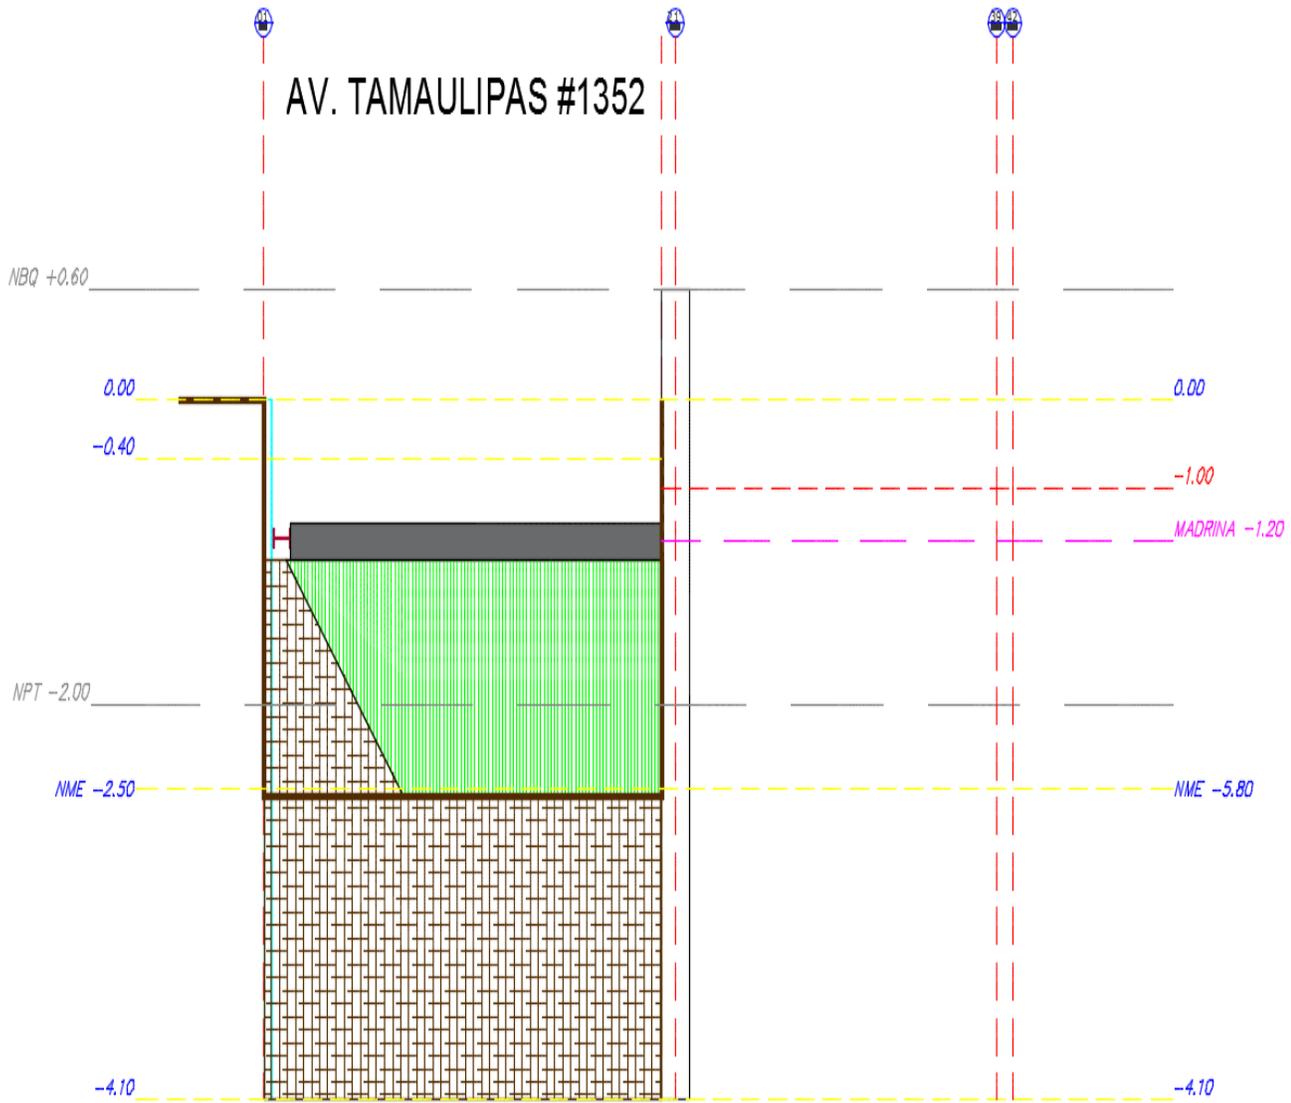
EXCAVACIÓN NIVEL -2.50
